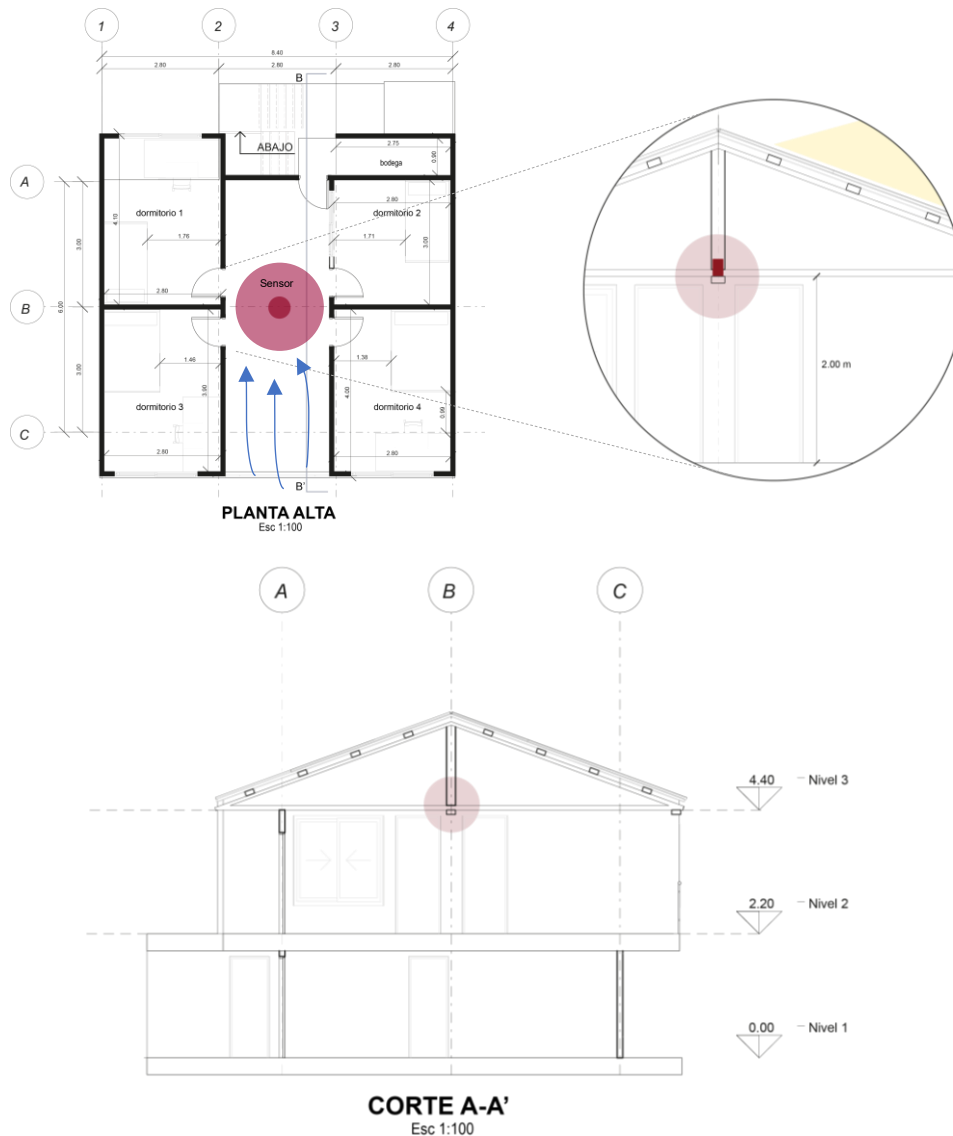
Puntos de colocación de instrumento de medición mostrada en planta arquitectónica y sección de tipología de vivienda 2
